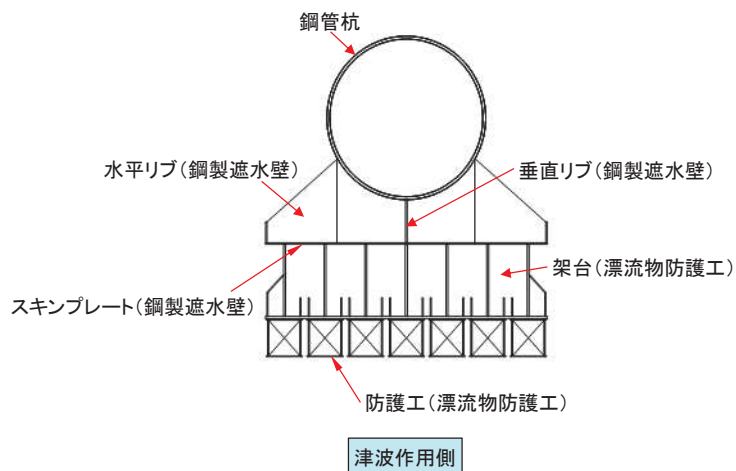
(2) 鋼製遮水壁及び漂流物防護工の構造図 (平面図)
